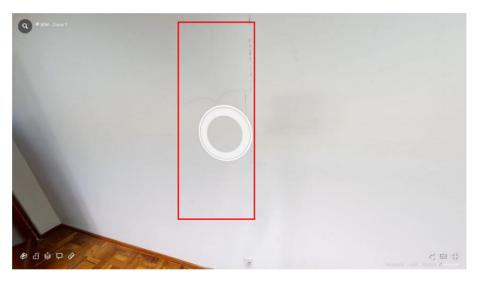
Sala de Reuniones (Fisuras)
